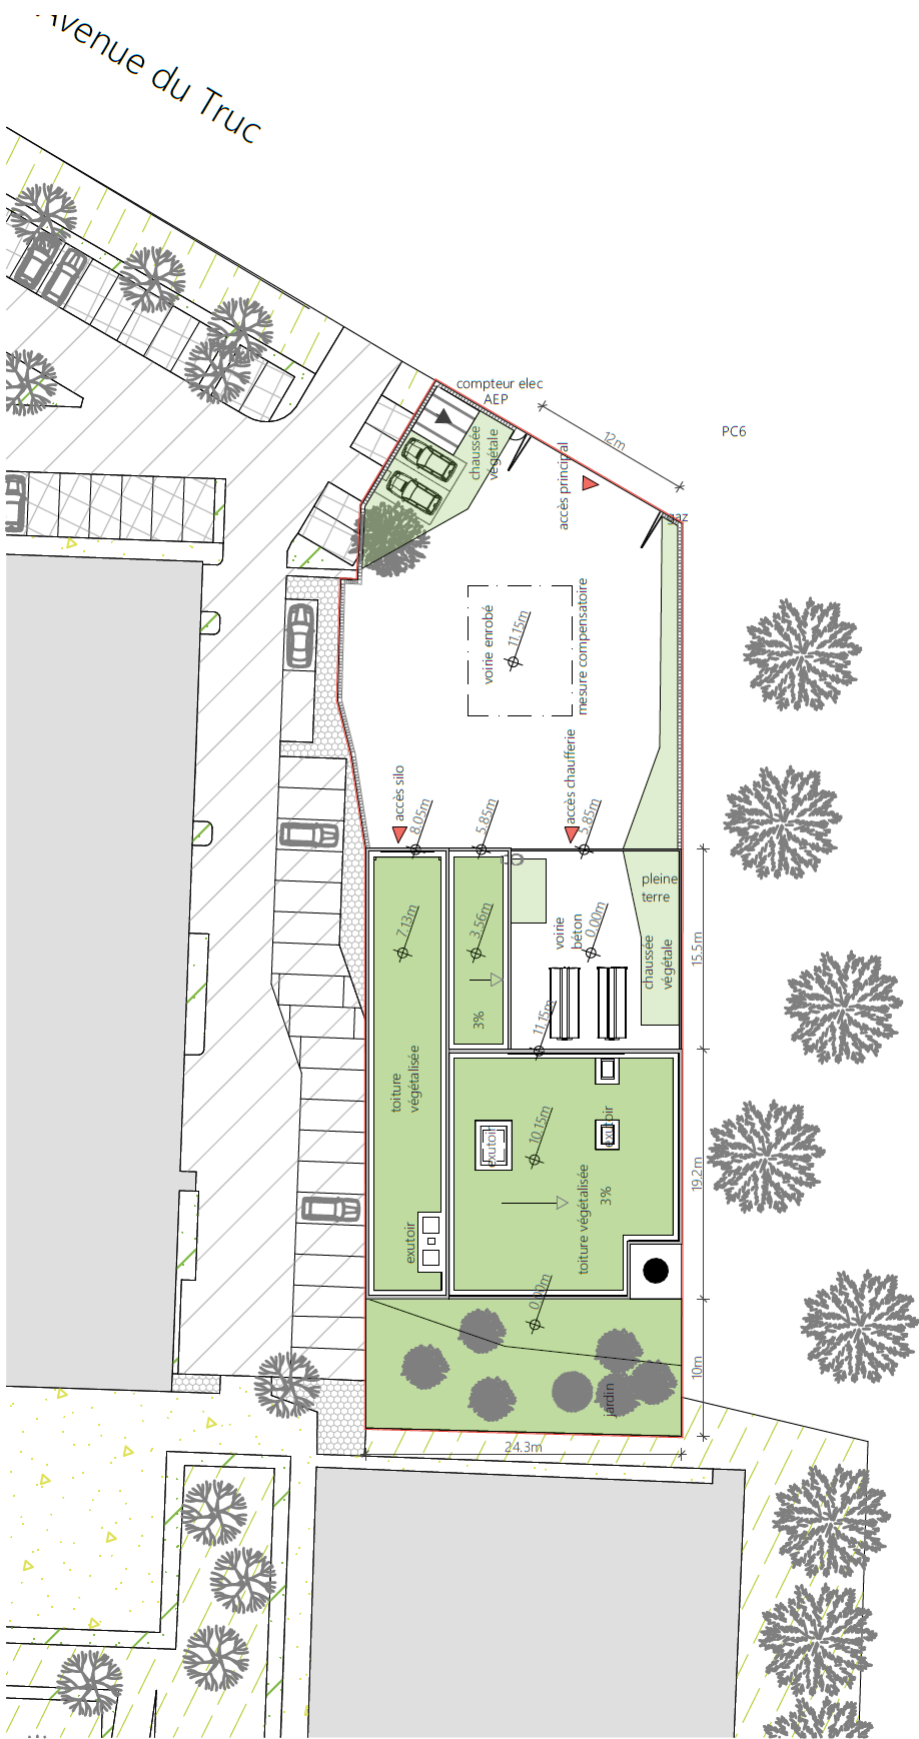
Plan masse du projet de chaufferie. Source : PC
